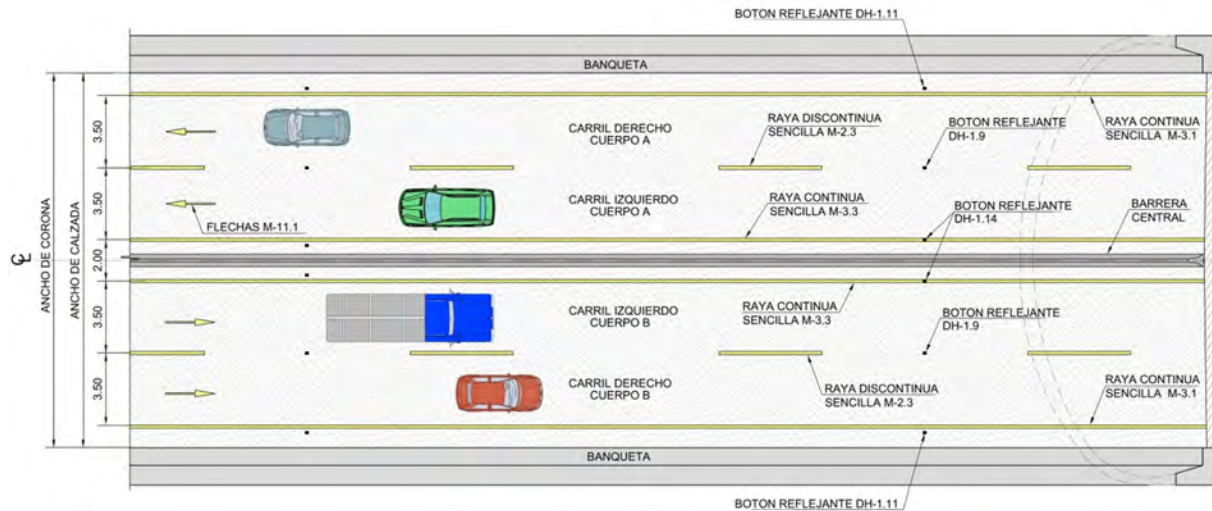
Señalamiento horizontal tipo, para túneles en carretera A4.
